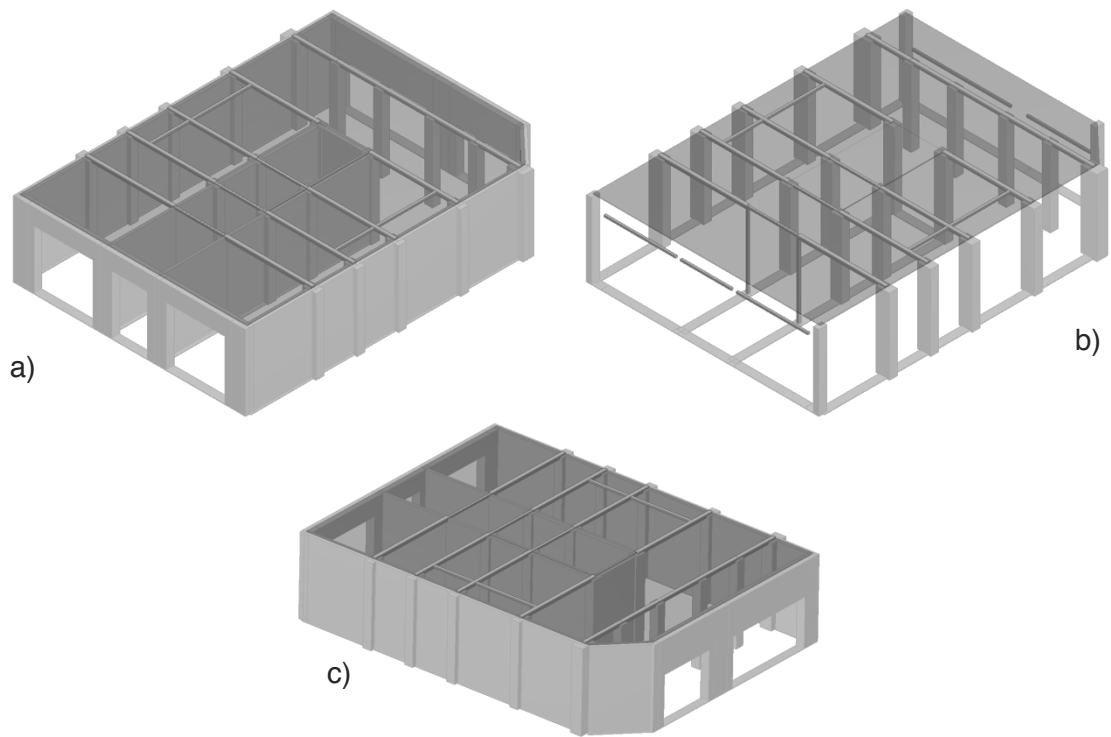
Modelo Tremuri edificio ED-03 planta baja. a) Vista isométrica fachada principal. b) Vista isométrica fachada principal sin muros. c) Vista isométrica fachada trasera
